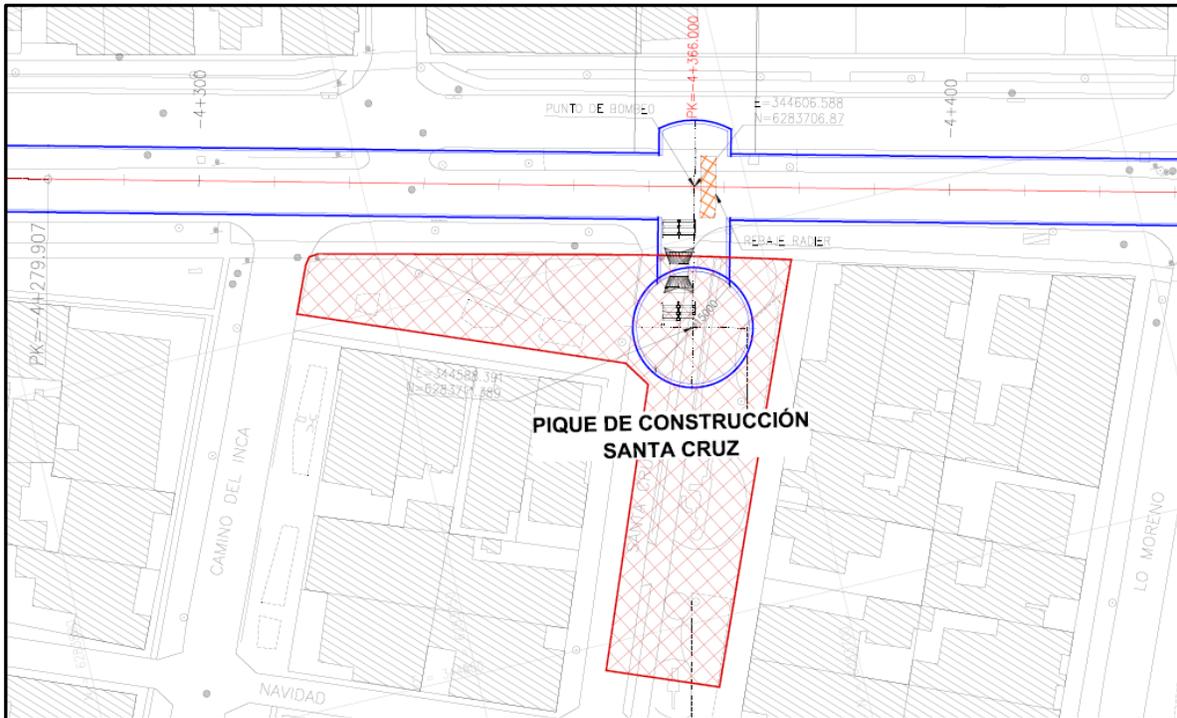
Planta Emplazamiento Pique Las Santa Cruz y Túneles Interestación
